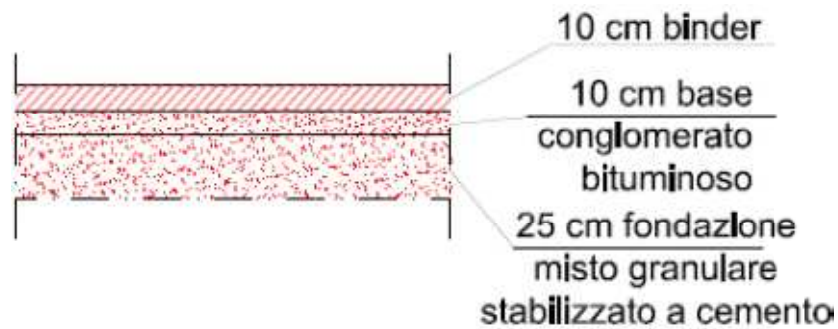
Progetto Esecutivo, sezione tipo risanamento profondo
